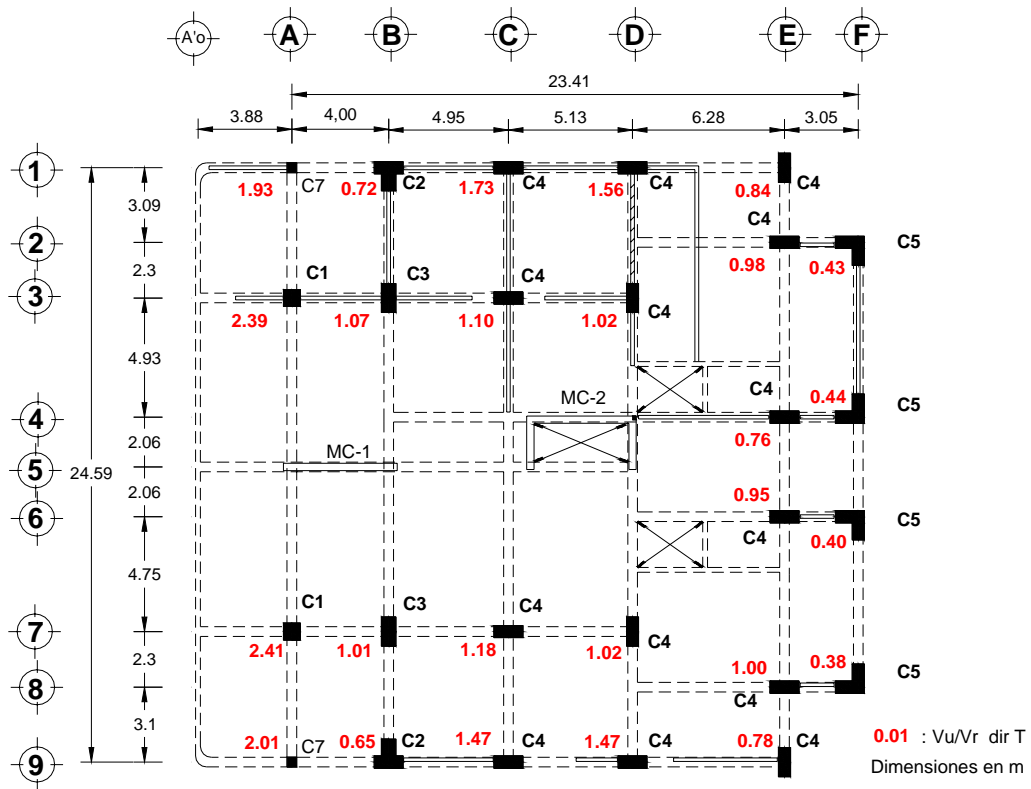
Relaciones entre el cortante último y el cortante resistente en las columnas de planta baja, para un análisis con $Q=4$ sin muros
